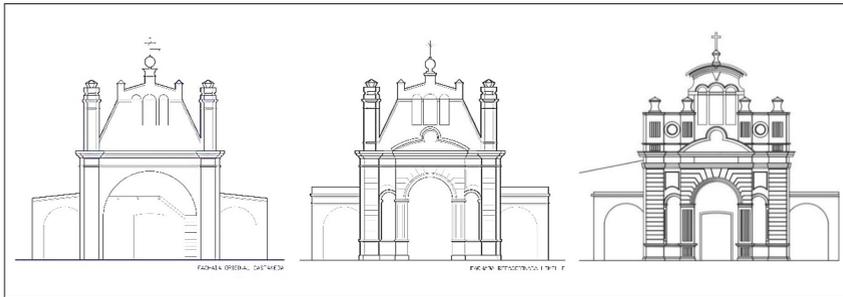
Tres fachadas de la capilla de Rincón. De izq. a der.: Capilla original. Relevamiento A. Lomello, 1895; fachada proyectada; fachada definitiva de la reforma de A. Lomello, 1895
